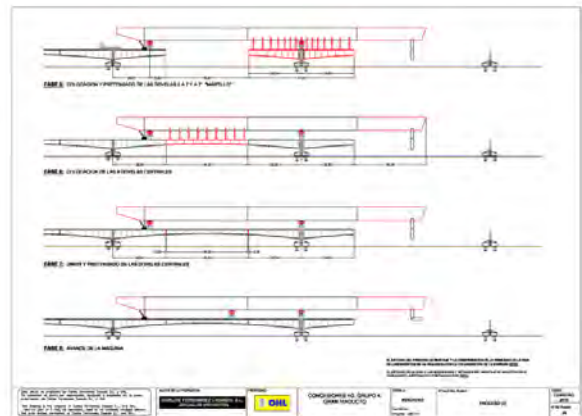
Alzados esquemáticos con la secuencia de ejecución vano a vano en dos fases.
